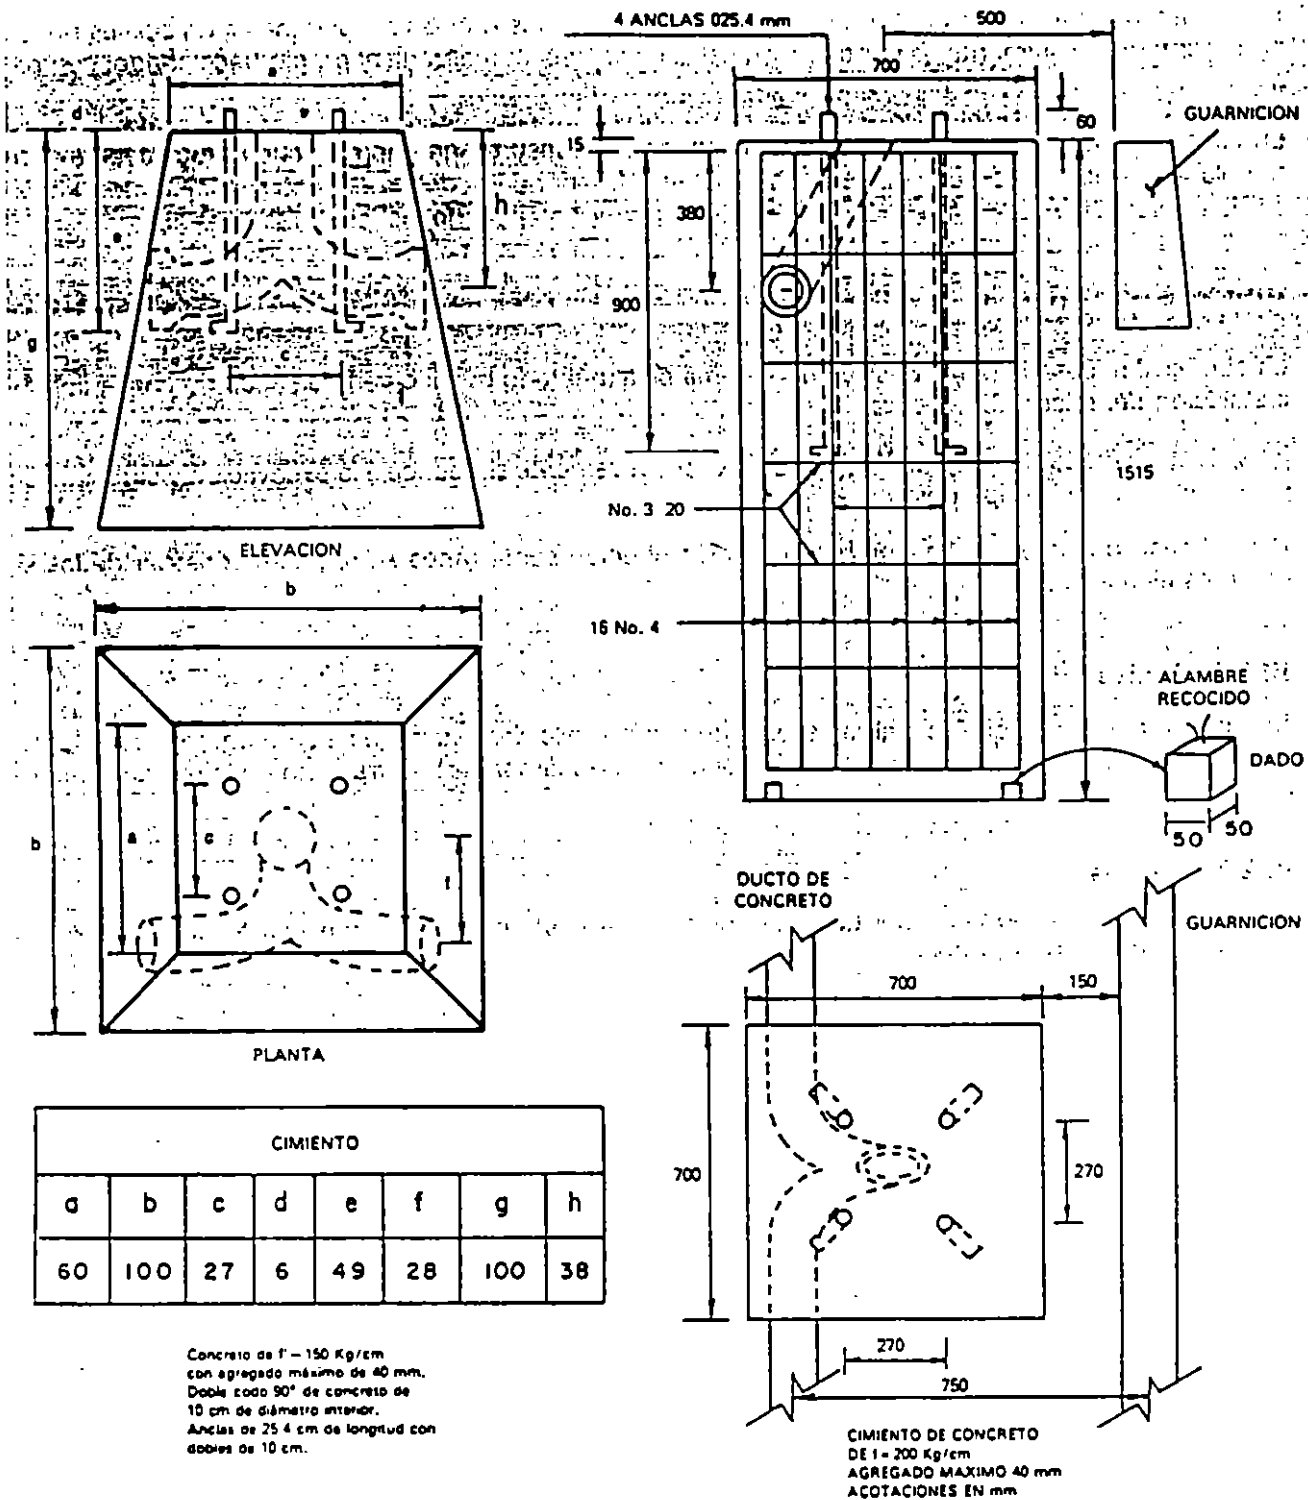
ARREGLO TÍPICO DE CIMENTACION PARA POSTE DE ALUMBRADO
